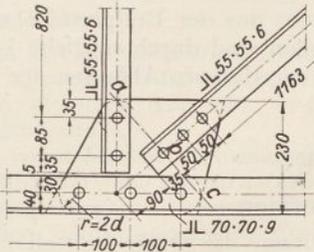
Aufzeichnen des Knotenbleches. Abb. 269. Knotenpunkt mit einspringender Ecke.
